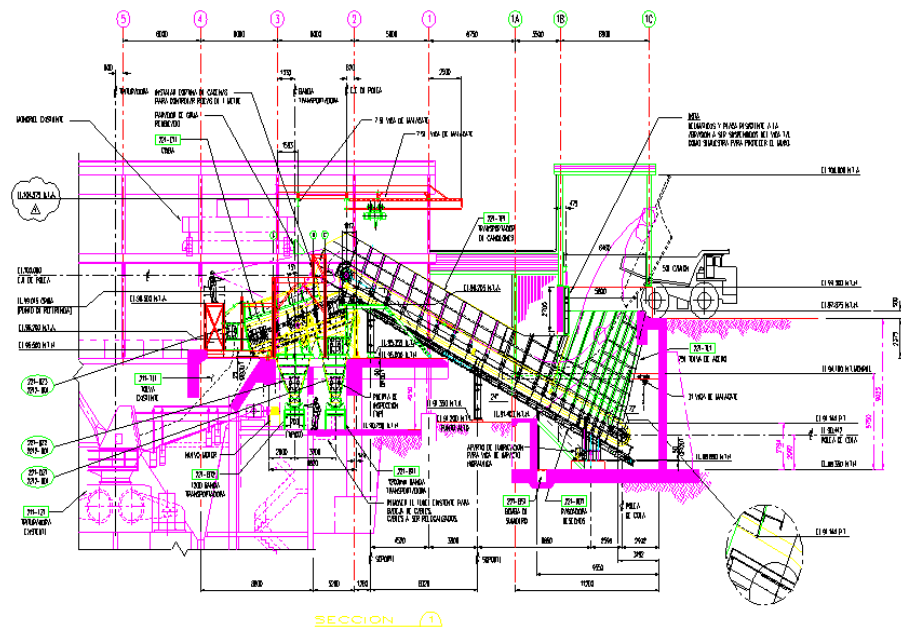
Plano de la Planta de Trituración de la Empresa "Cementos Cienfuegos" S.A. Fuente: Goytisoló et. al. 2006)
